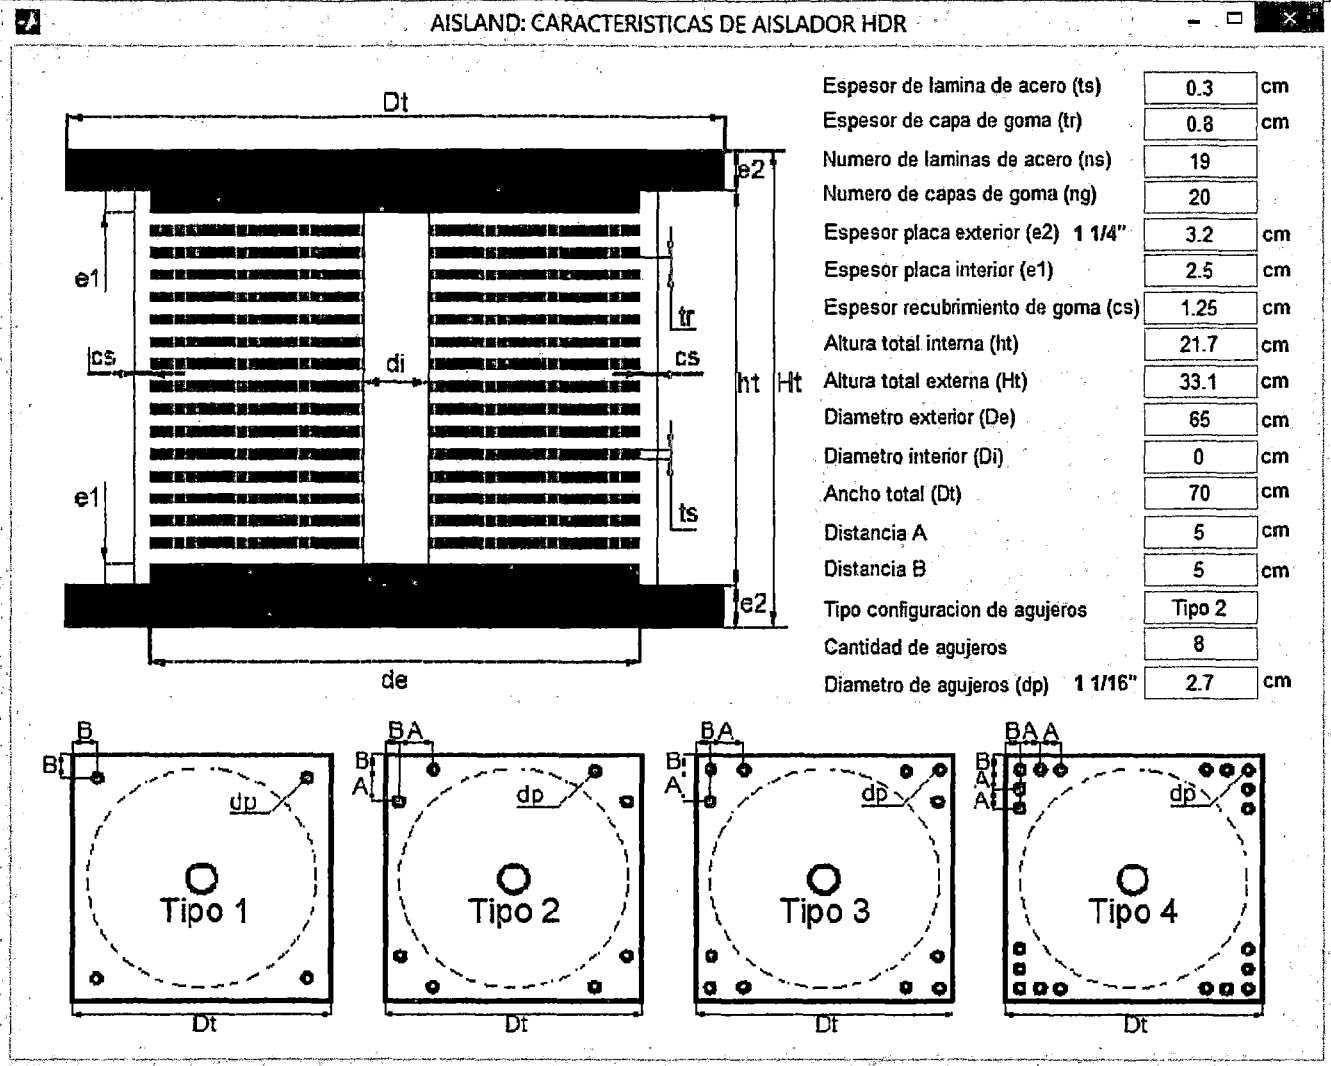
Caso HDR1+HDR2:Dimensiones geométricas del aislador diseñado HDR2.
